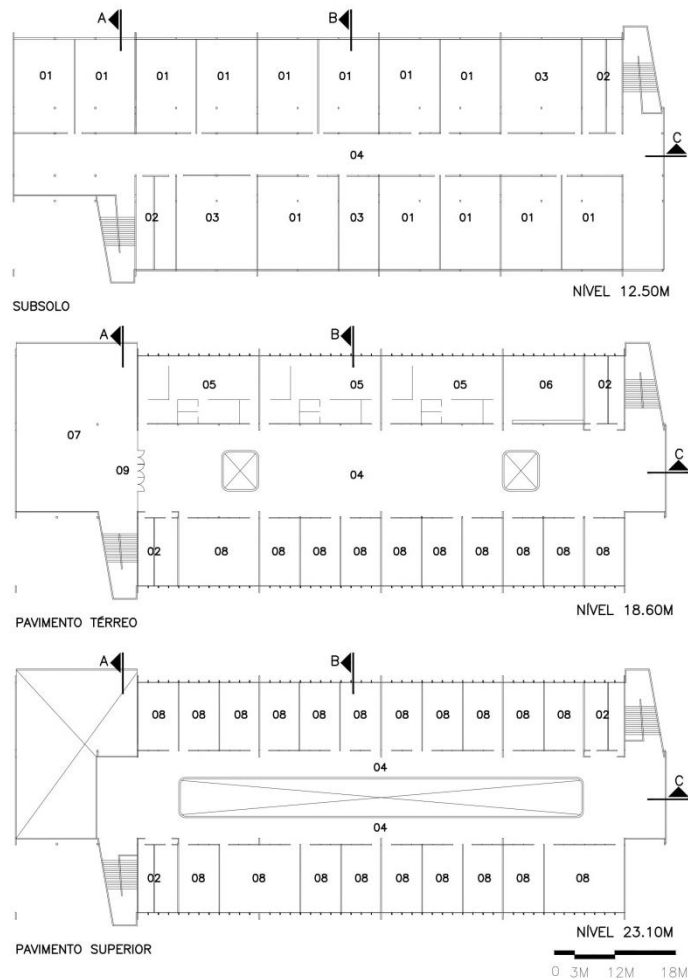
Módulo 1º Etapa Construção Bloco Didático Plano UMA. Fonte: Prancha 15 do Plano de Implantação Imediata – 1º Sub-Etapa Plano UMA – Arquivo digital disponível no COMCAP-UEM.
